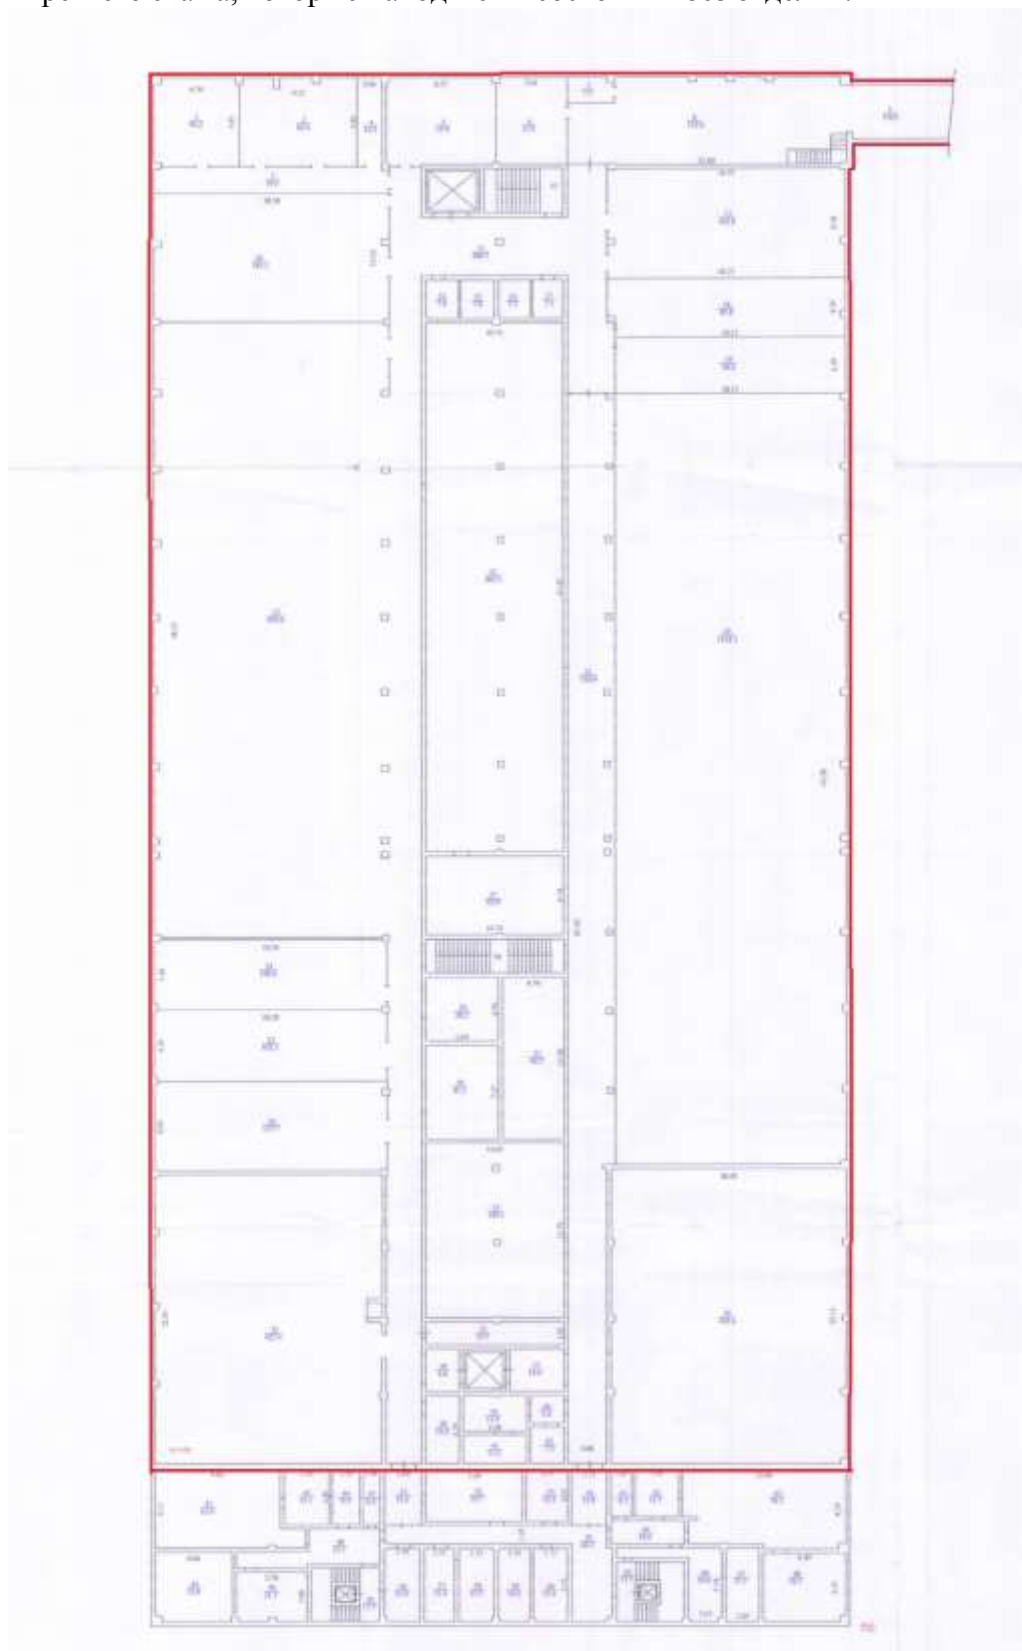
Границы помещений третьего этажа без отделки
